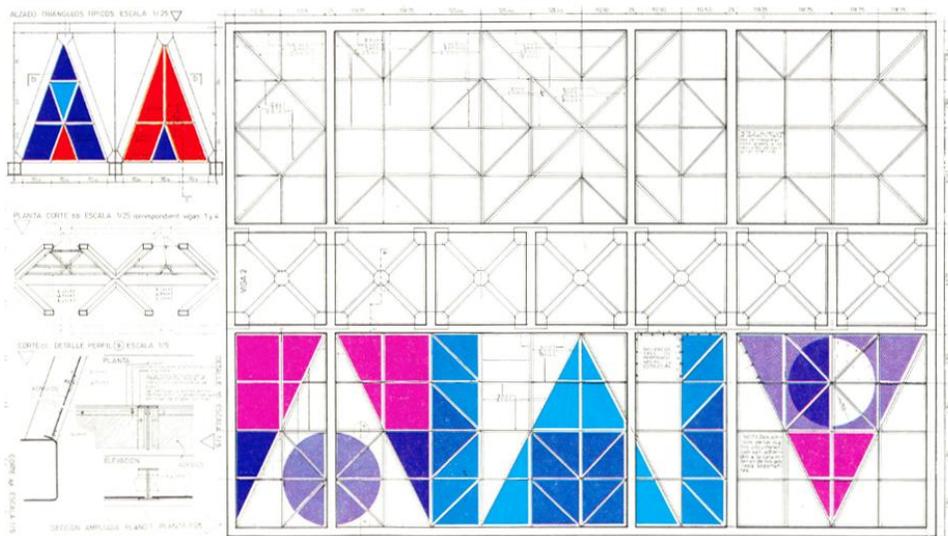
Ilustración LII: Plano del vitral o "Claraboya de ingreso" hecho de acrílico por Juan Bernal Ponce. Es interesante el hecho de que los detalles del vitral incorporado en la estructura se dibujen junto con detalles de la estructura, hecho que resalta la idea de que ambas se entienden como un mismo elemento indivisible. (AUCA Nº22, p.70). Ilustración LIII: Juan Bernal Ponce, Volantín, Vitral de acceso, 1971. Cortesía: Lateral Arquitectos.
